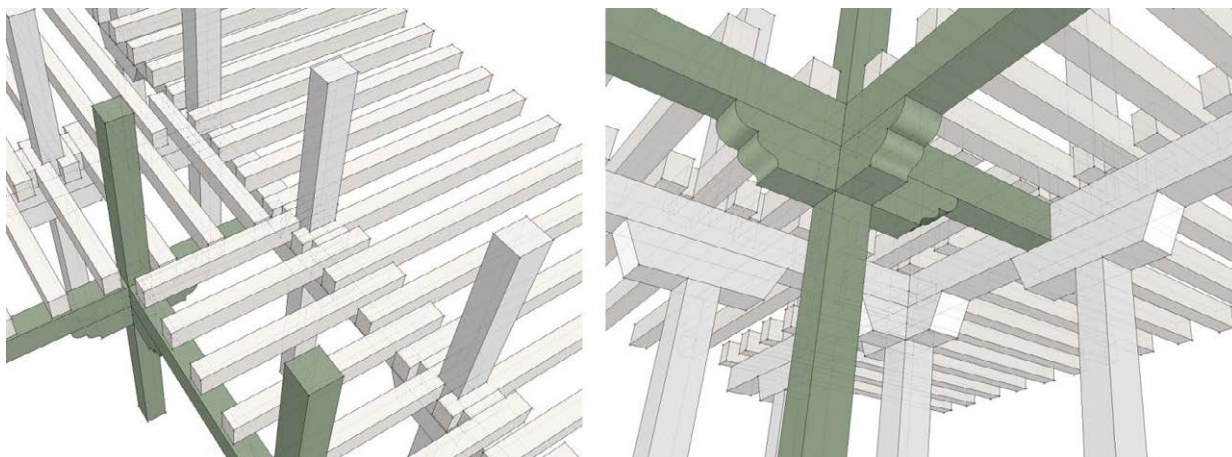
Apoyo de la carrera del entramado del corredor sobre la carrera del muro de fachada
